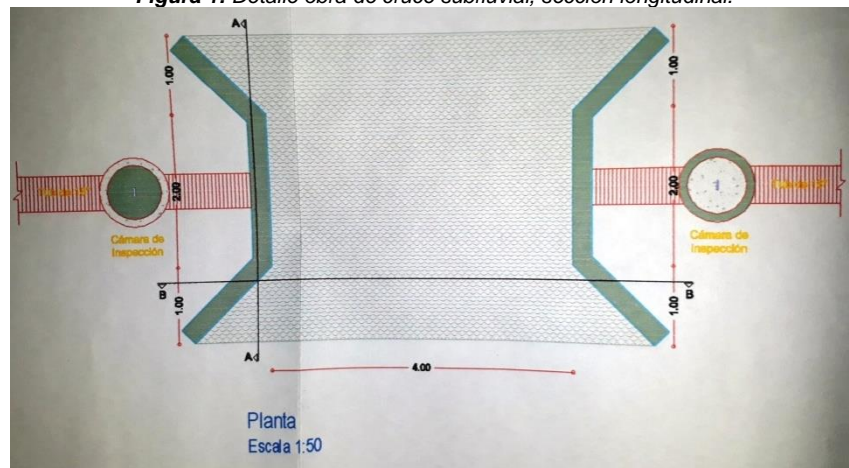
Detalle obra de cruce subfluvial, sección en planta.
